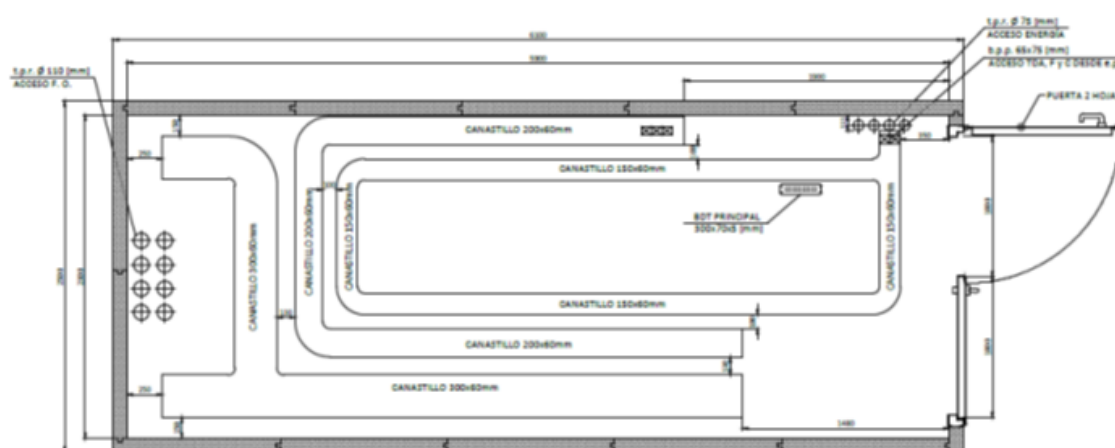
Planta Canalizaciones Interiores POIIT panelizado
